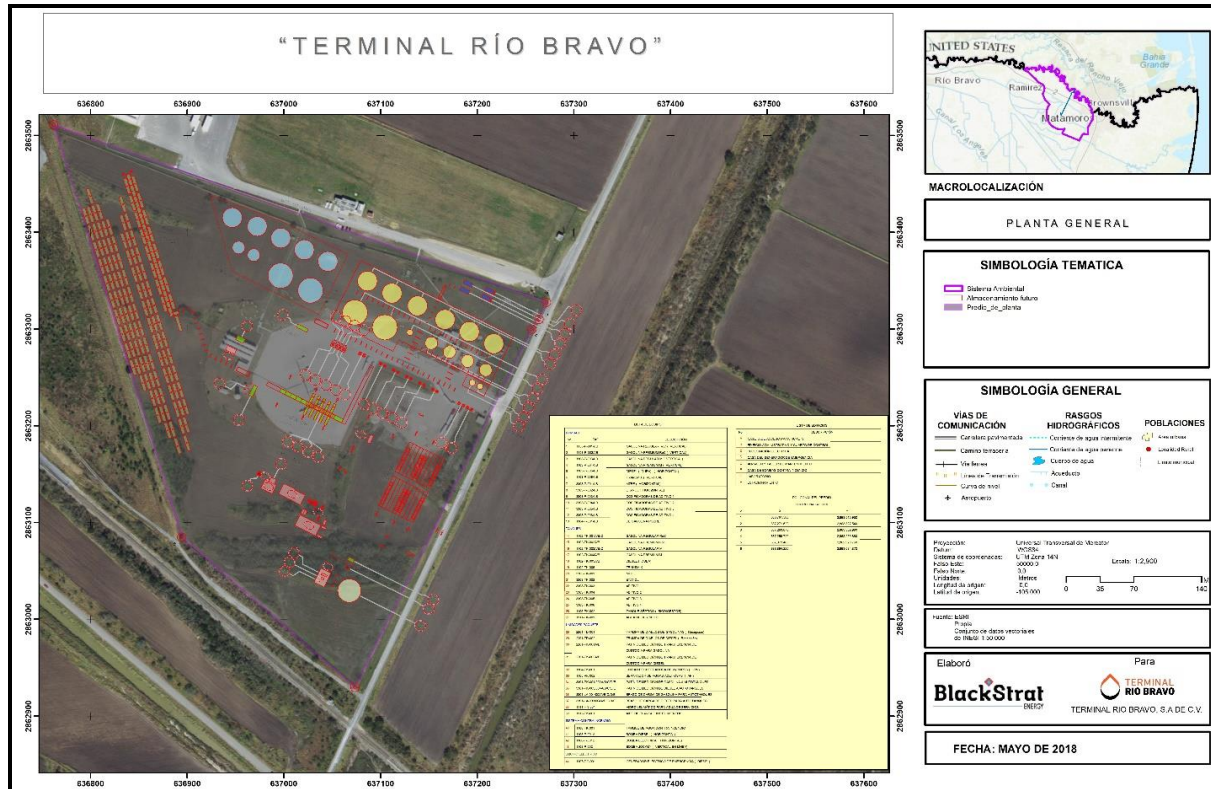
Arreglo general del proyecto "Terminal Río Bravo".
